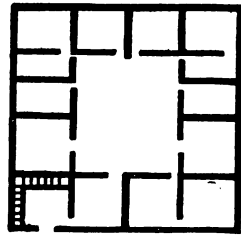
PLAN D'UNE MAISON A COUR CENTRALE AVEC ESCALIER MENANT AUX TERRASSES
